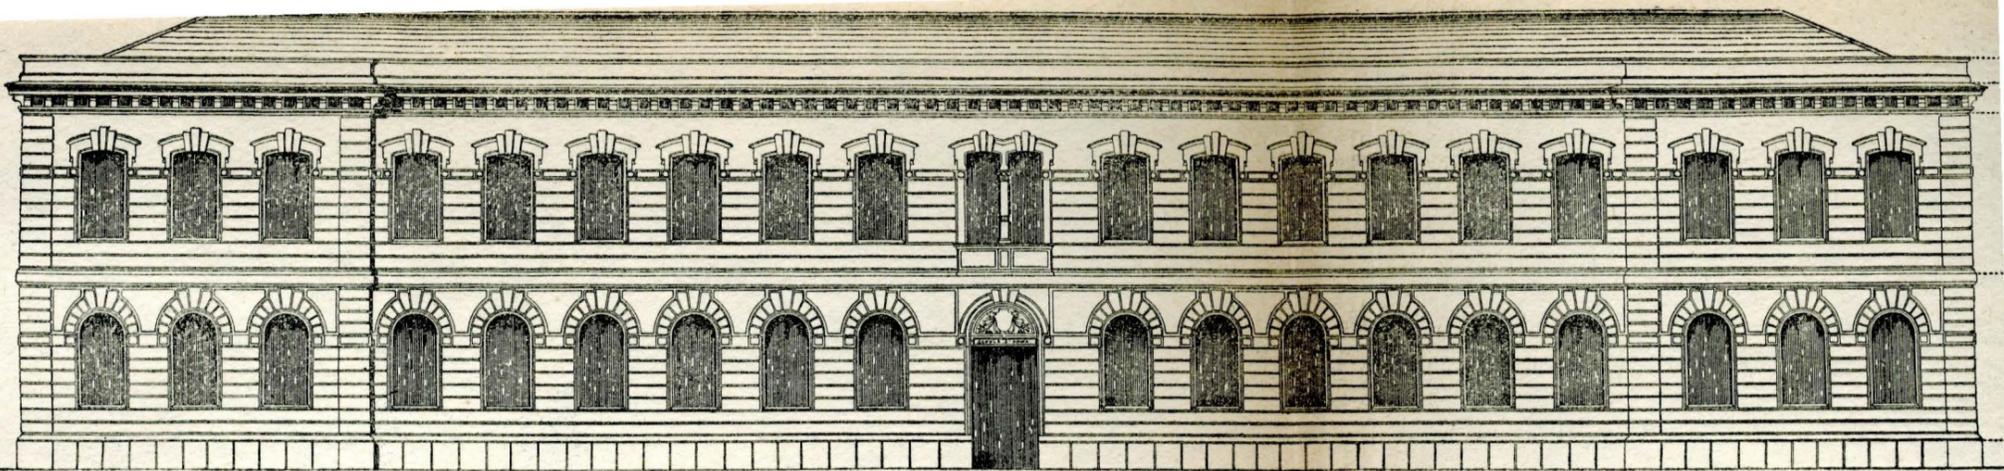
Prospetto geometrico della facciata principale a levante - Scala 1:200
